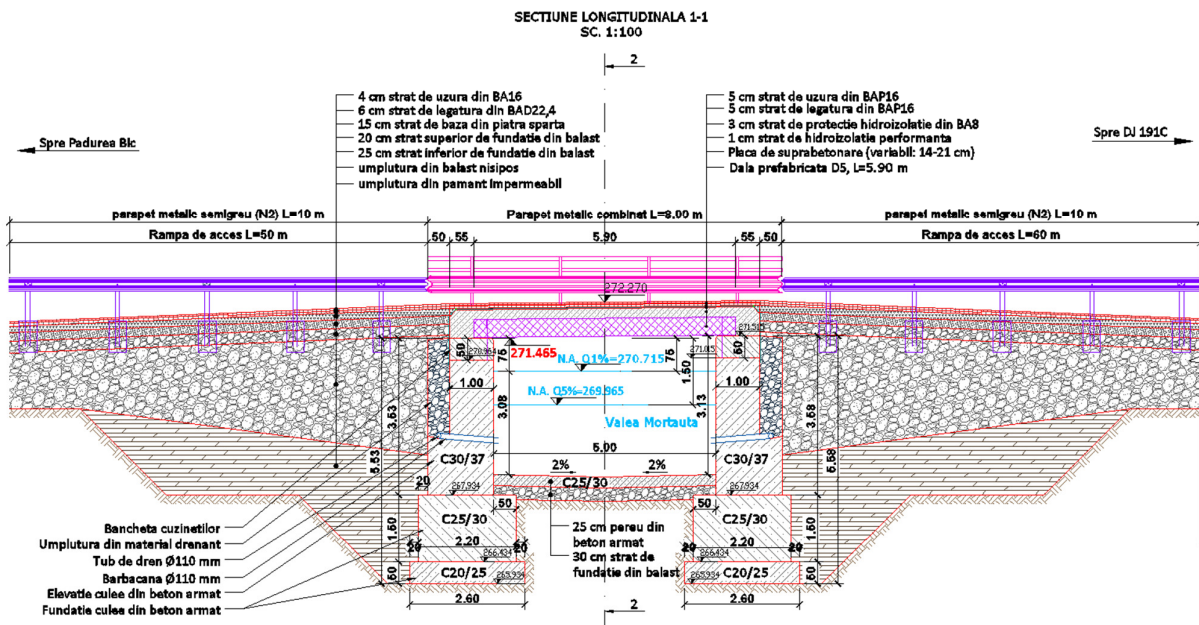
Secțiune longitudinală prin podeț cu suprastructură din beton, pe dale prefabricate
